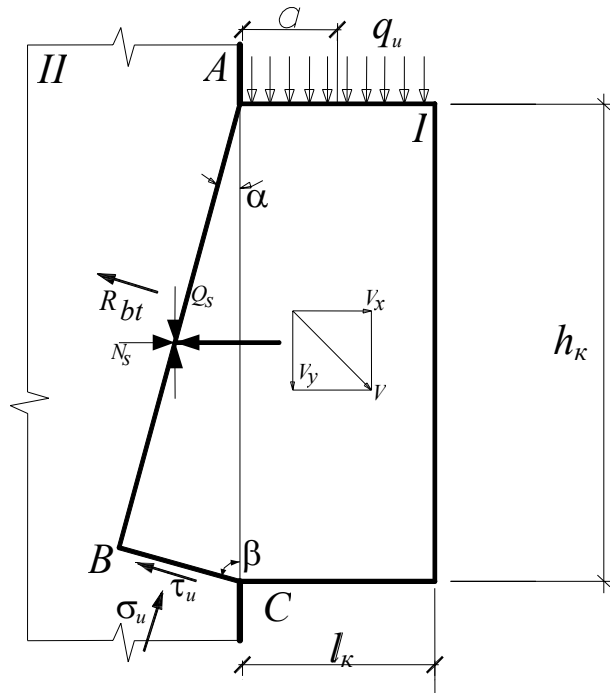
Кінематично можлива схема руйнування окремих прямокутних залізобетонних шпонок при зрізі при розташуванні арматури в один ярус
